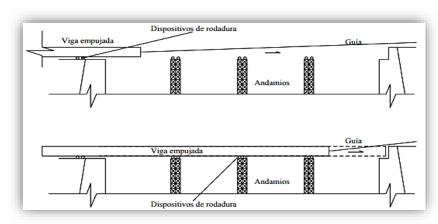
Fuente: guía para el diseño de puentes con vigas y losas (Manrique, 2004)
